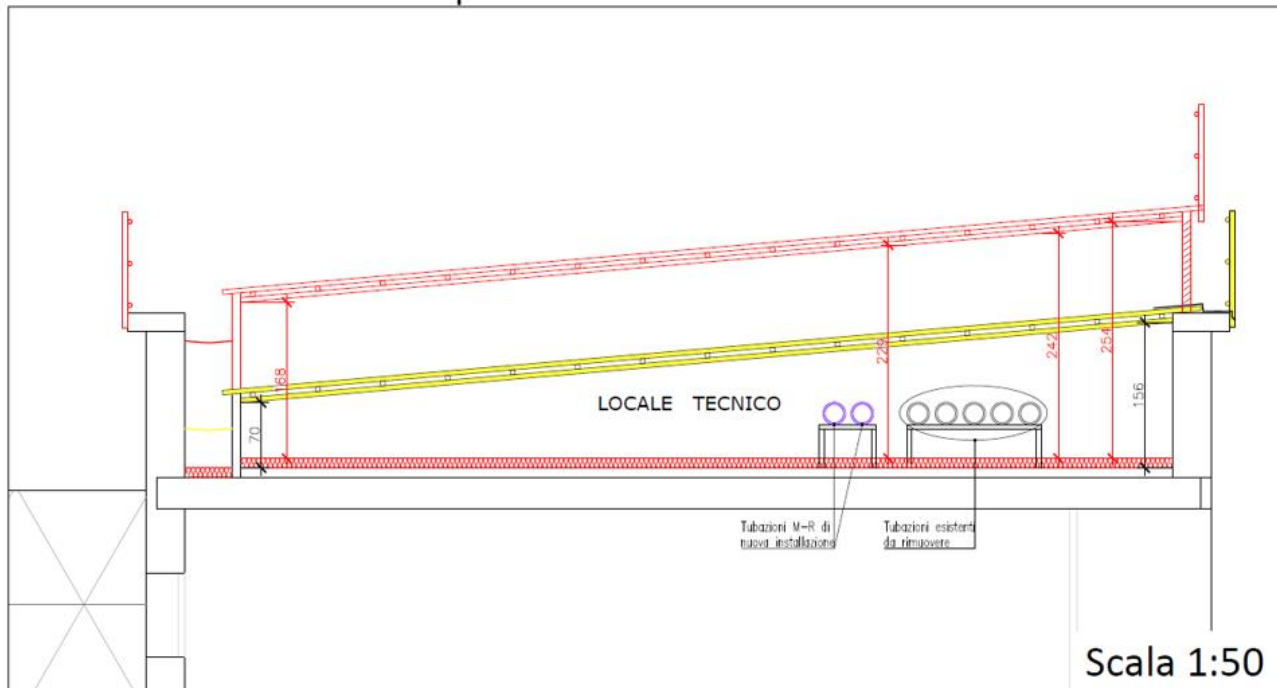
Sezione del sottotetto con particolare relativo al progetto di rialzo della copertura e sostituzione delle dorsali [5]
